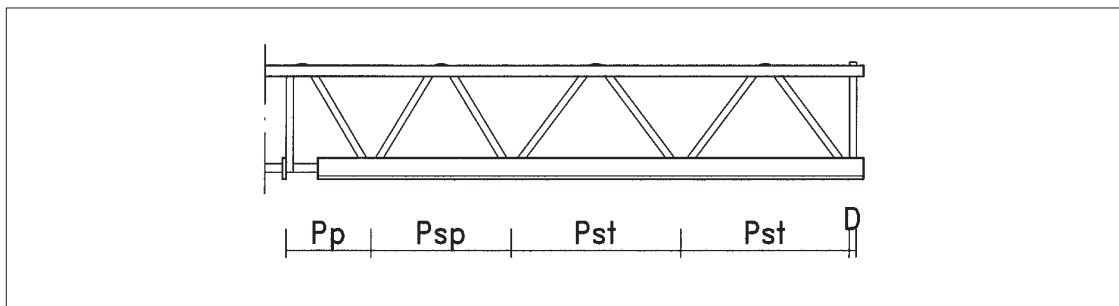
Disposizione passi sbalzo con fondello in cls.
